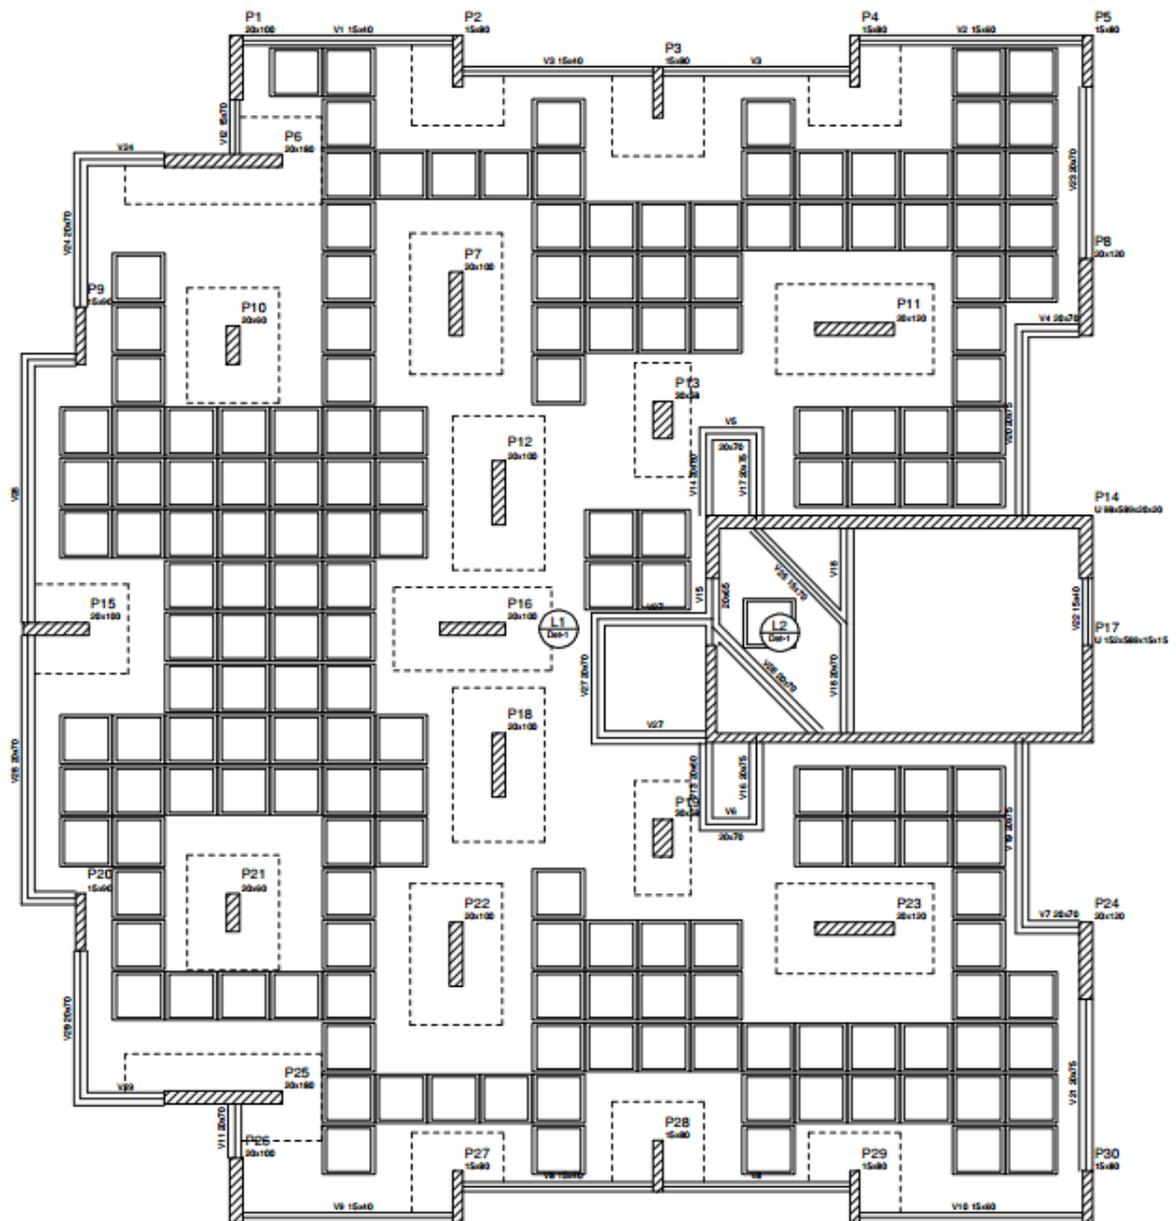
Fôrma do Sistema com Laje Nervurada com vigas de bordo e capitéis.
